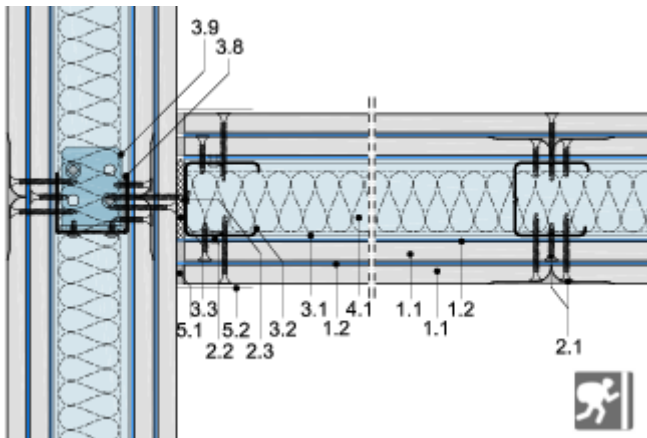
Wanddecke Doppelständerwand RC 3 mit erhöhtem Schallschutz
